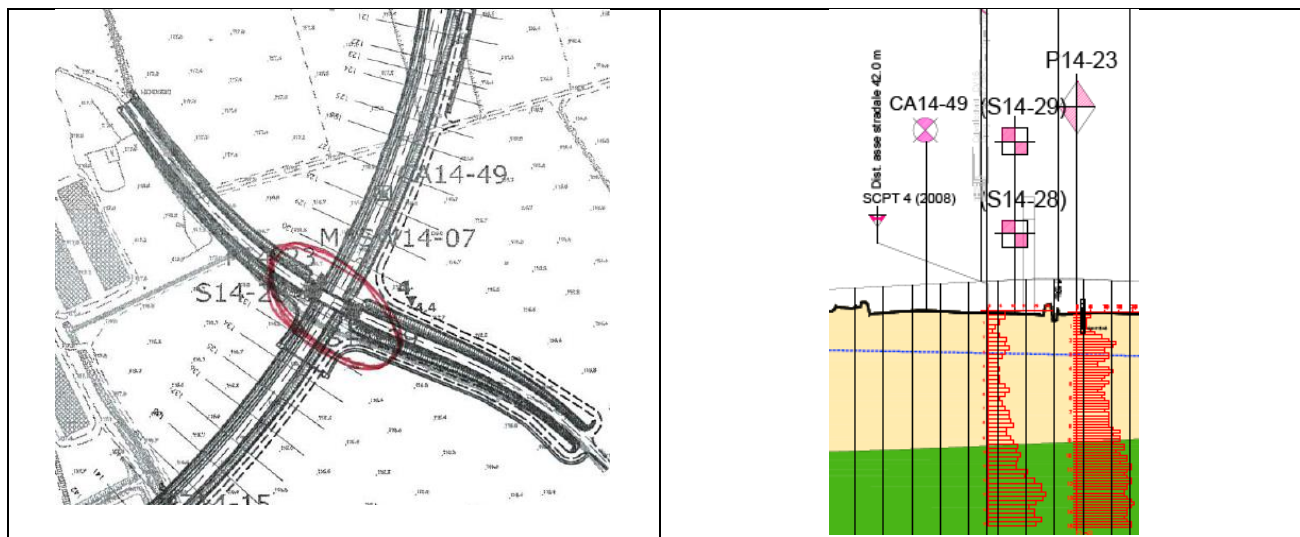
Stralcio planimetrico e stralcio profilo geologico Cavalcavia intervento 30
